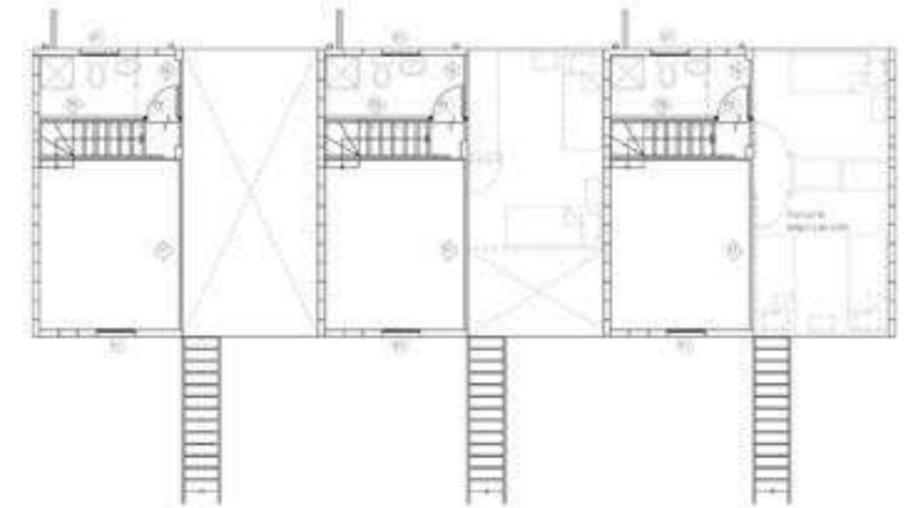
Quinta Monroy. Primeiro Pavimento. Fonte. Archdaily/ELEMENTAL
